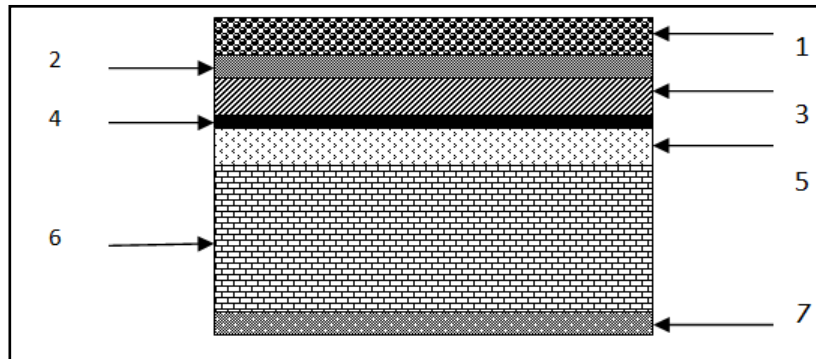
Coupe d'un plancher terrasse en corps creux (inaccessible).
